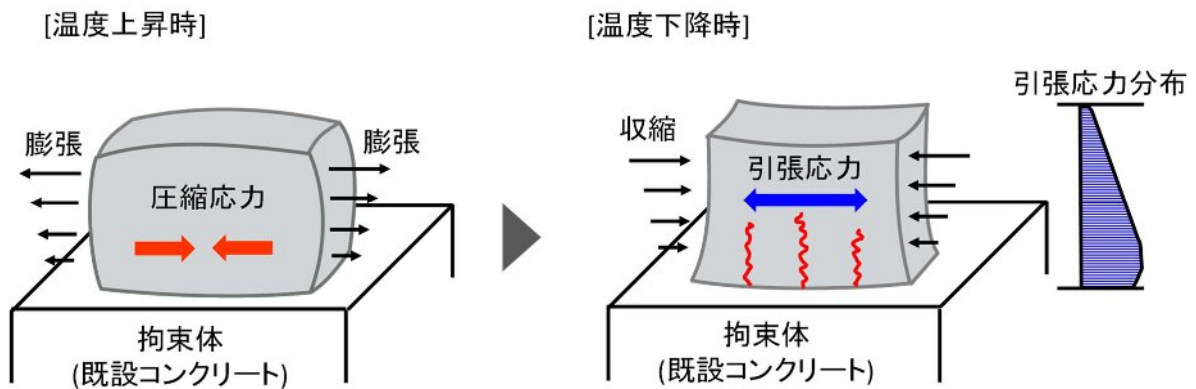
外部拘束による温度ひび割れのイメージ図
